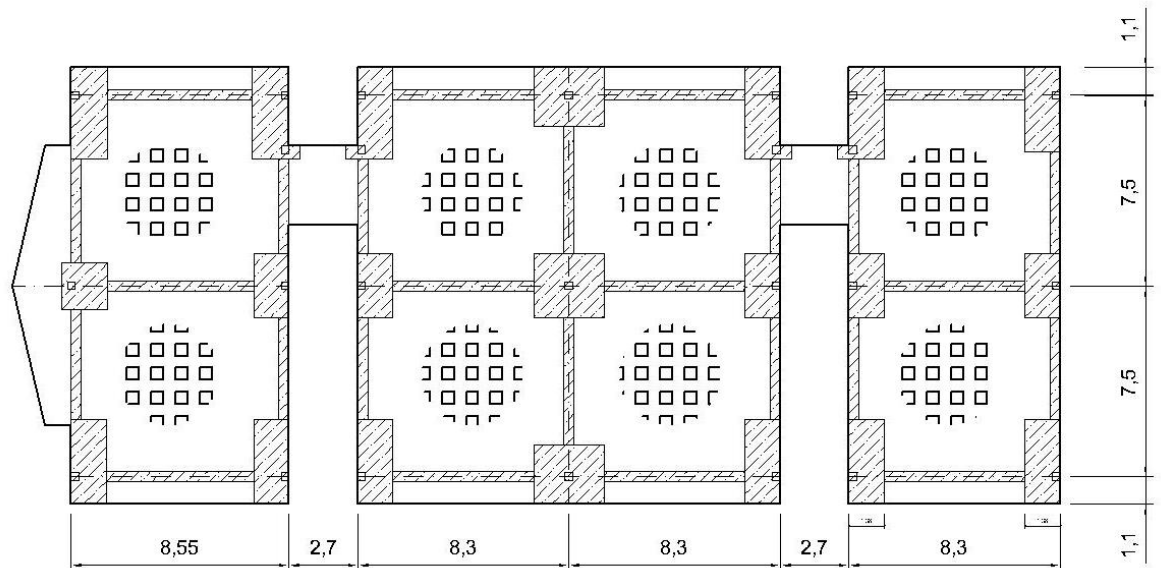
Planta Tipo para el Diseño de la Losa Postensada (Montaño, 2006)
